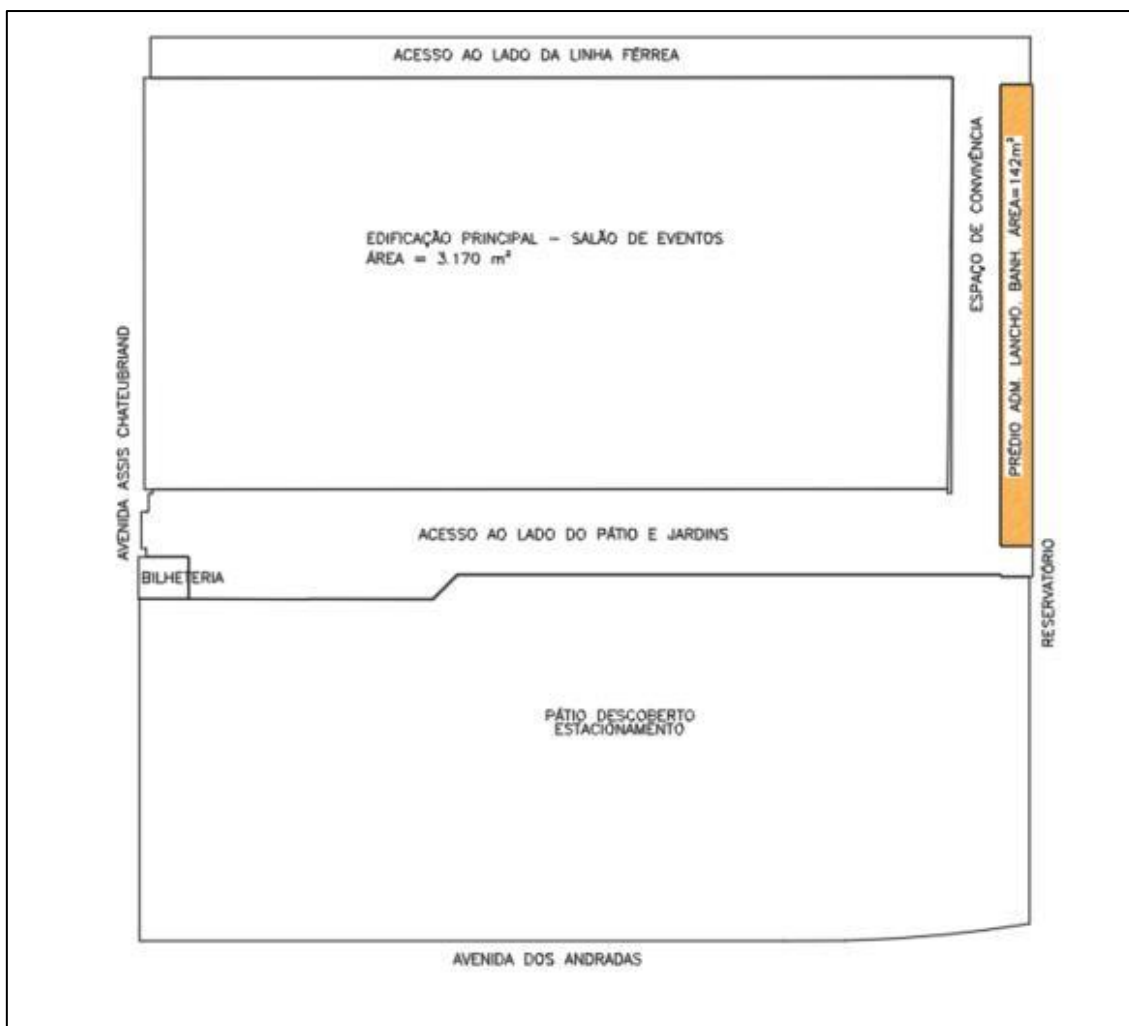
Planta chave 1º pavimento prédio administrativo- Banheiros e Lanchonete.
